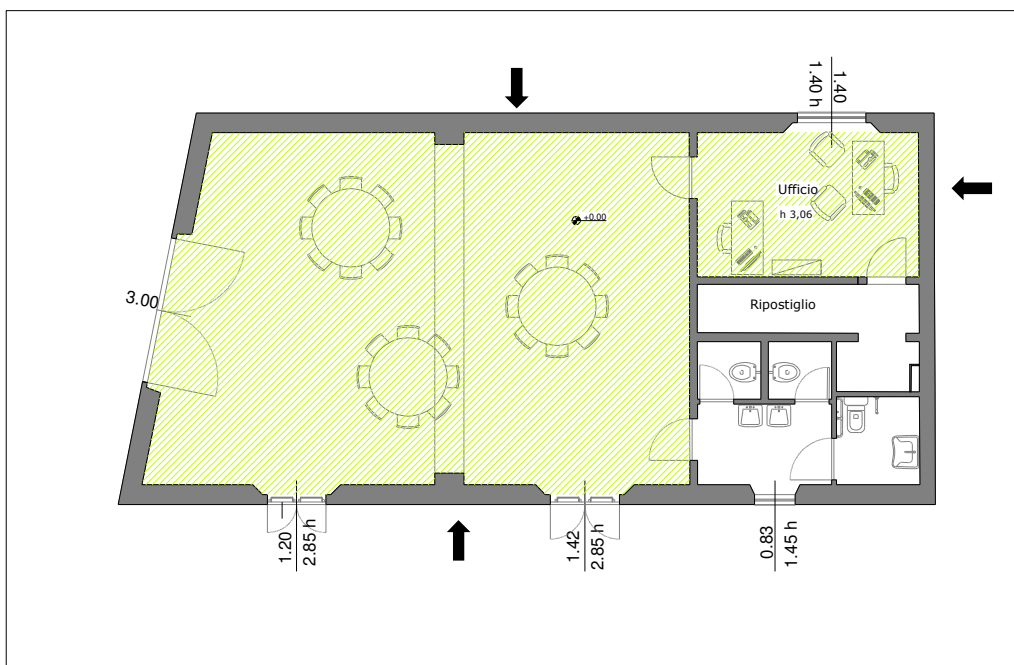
Pianta piano terra dell'edificio con indicazione degli "ambienti abitativi" e delle pareti di facciata oggetto di verifica
